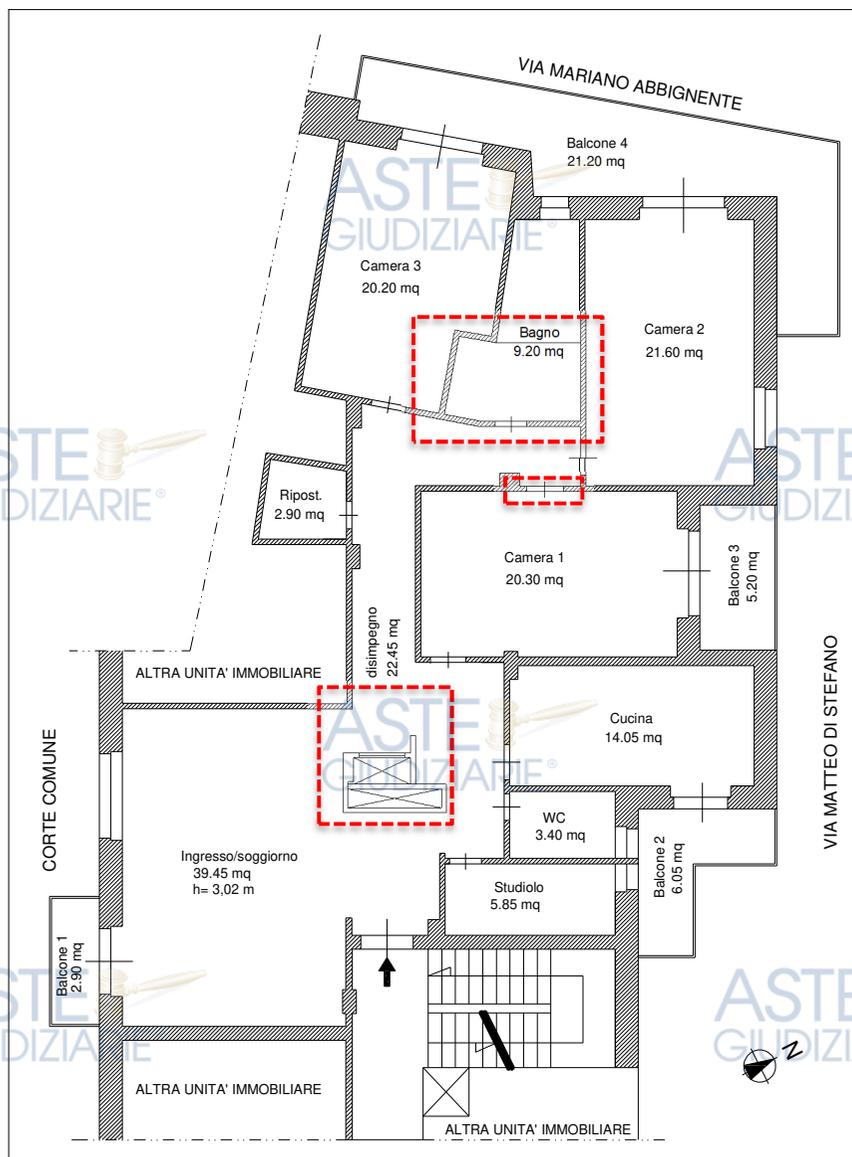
Pianta di rilievo dell'abitazione pignorata – (Lotto 2)
